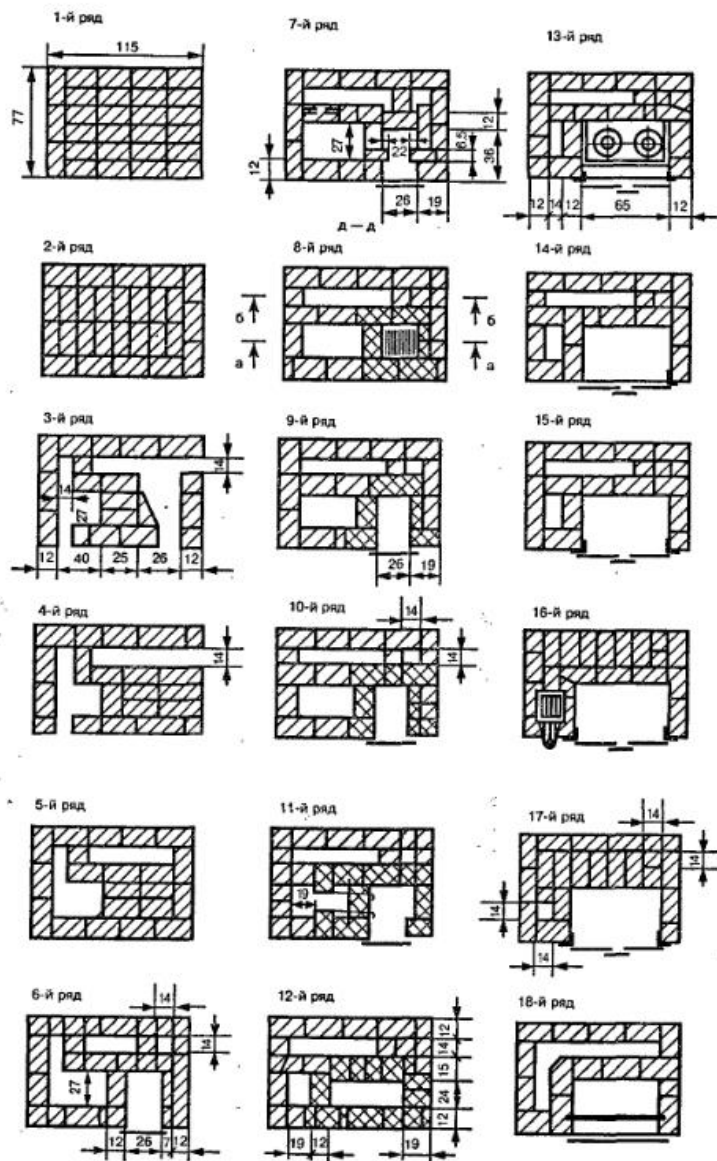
Порядовки печи ИП-1. Размеры в см
